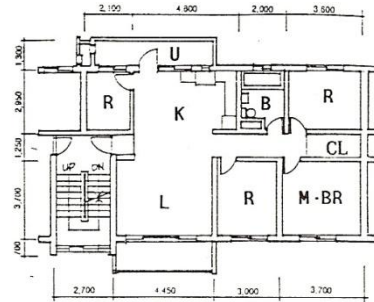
Grundriss eines Banpo-Wohnhochhauses
